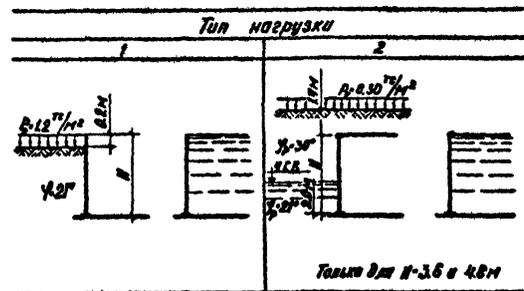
Схемы расчетных нагрузок на стены цилиндрических сооружений высотой 3,0 + 6,0 м.
